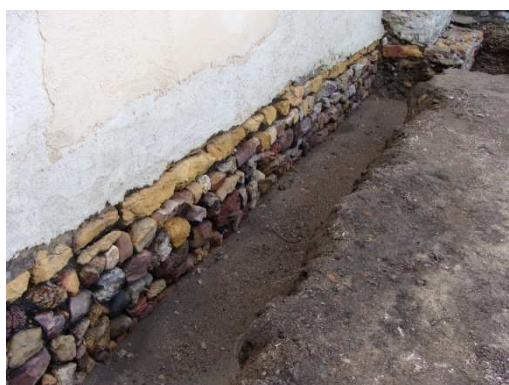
Nef, mur gouttereau nord. Dégagement des fondations lors des travaux de 2008-2010, par l'archéologue Gilles Rollier (photo de S. Couture).
